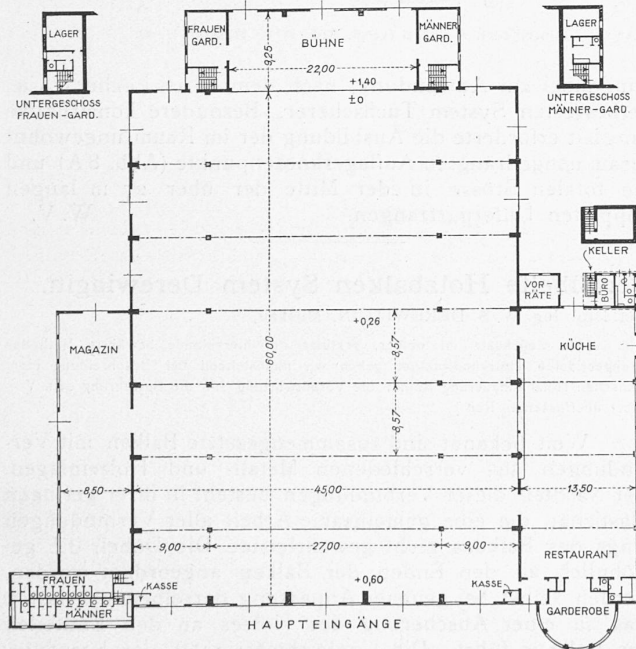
Grundriss der Markt- und Ausstellungshalle in Chur. — 1 : 800.
